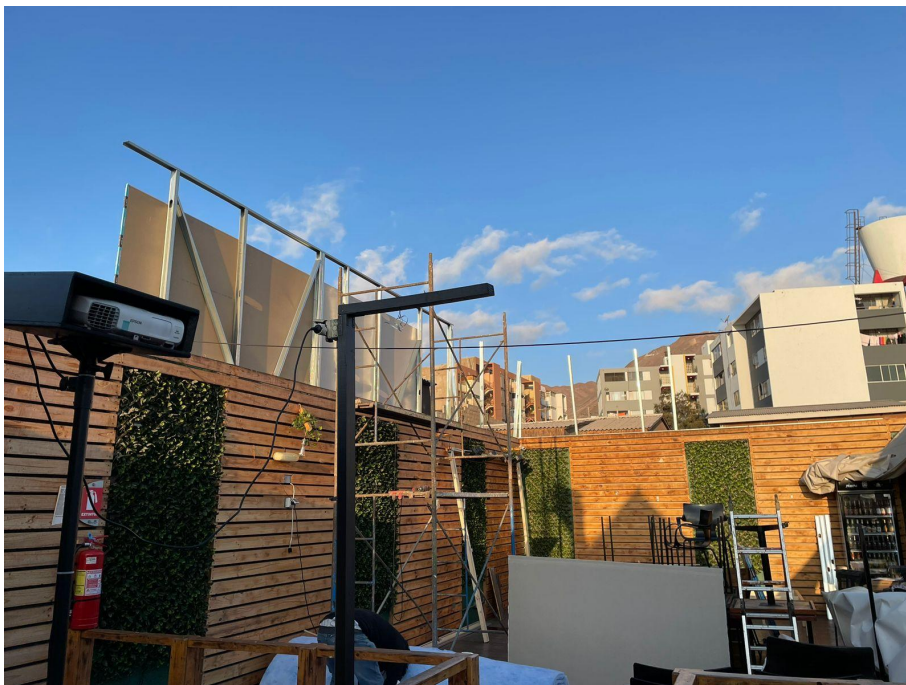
Fotografía instalación de aislante térmico acústico Fiber
